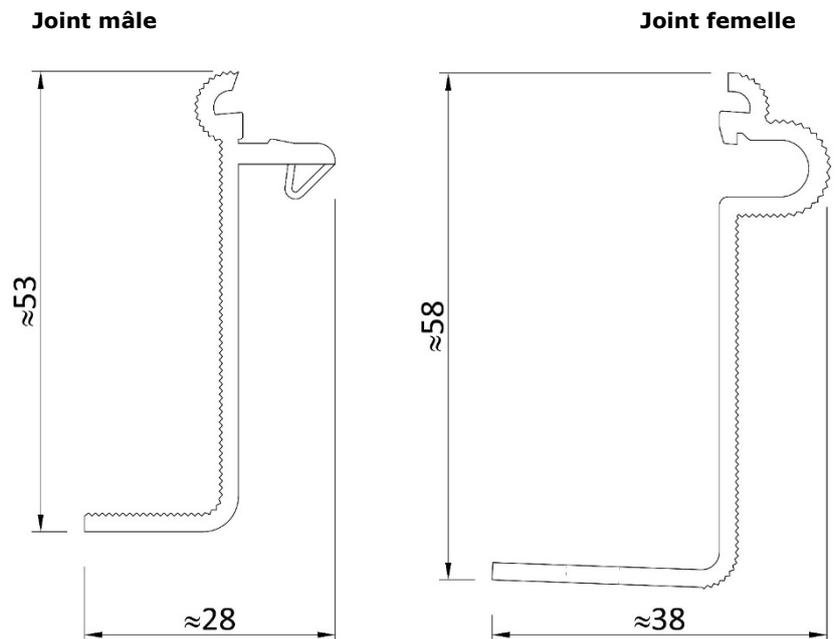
Principe d'emboîtement et fixation cachée des panneaux MYRAL
